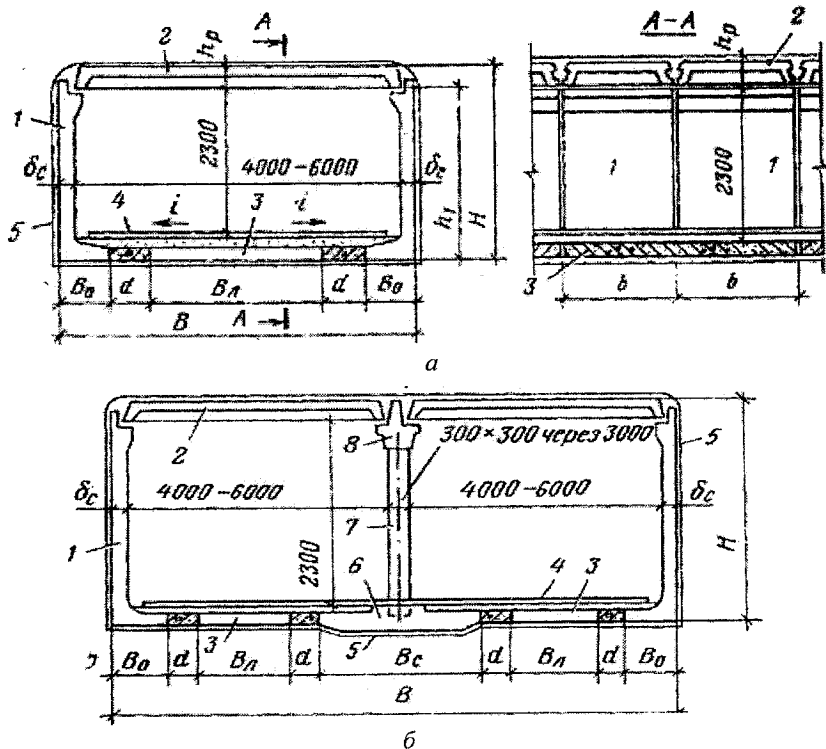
Конструкції однопрольотного (а) і двопрольотного (б) пішохідних тунелів із збірних залізобетонних елементів: 1 – стіновий блок; 2 – блок перекриття; 3 – лотковий блок; 4 – покриття підлоги; 5 – гідроізоляція; 6 – підколонник; 7 – колона; 8 – прогін
